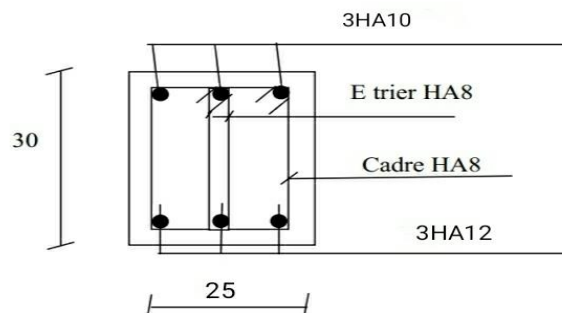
Le ferrailage de la poutre de chaînage
